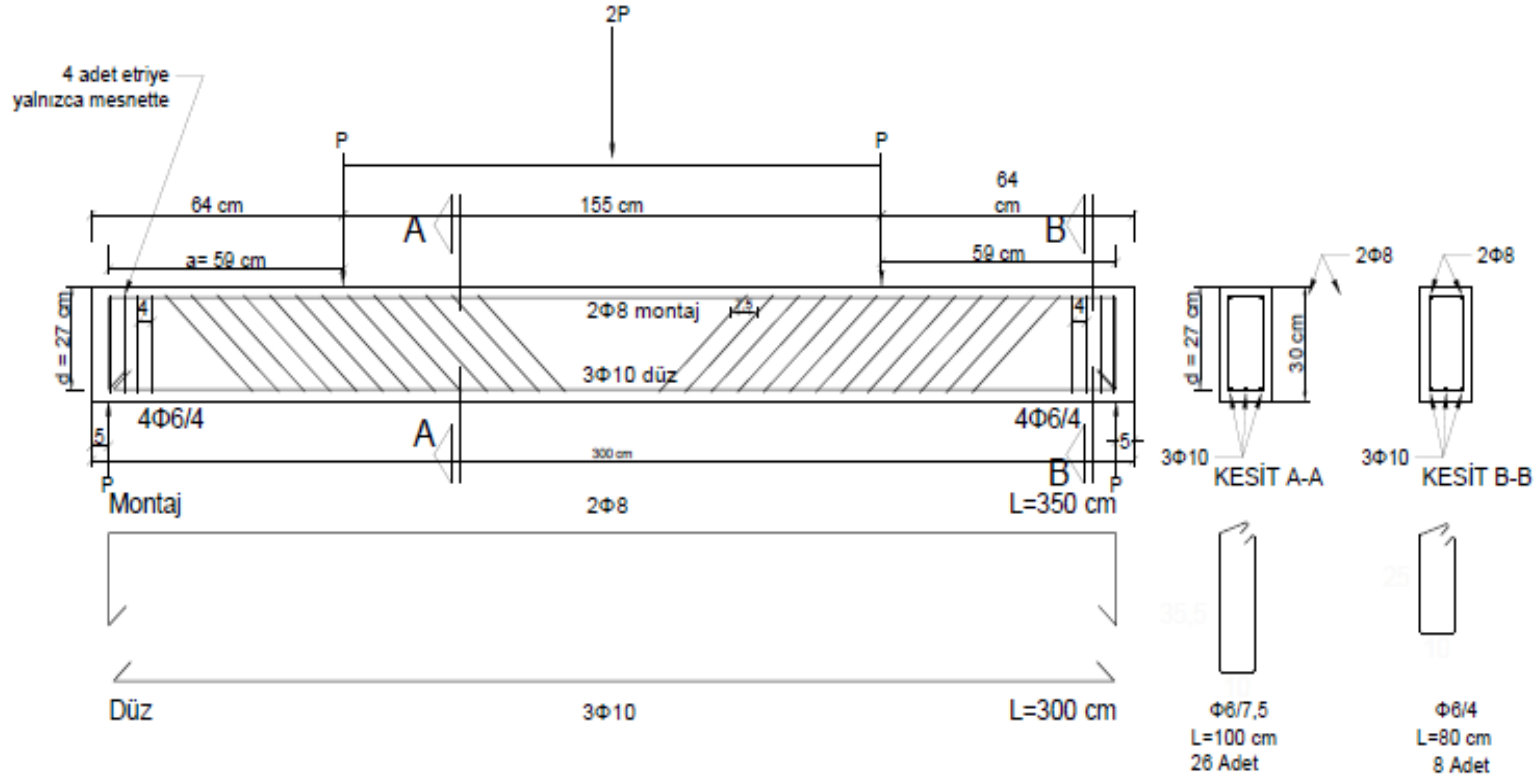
Betonarme Kiriş -2 Referans Elemanı (RCB-RE2)
